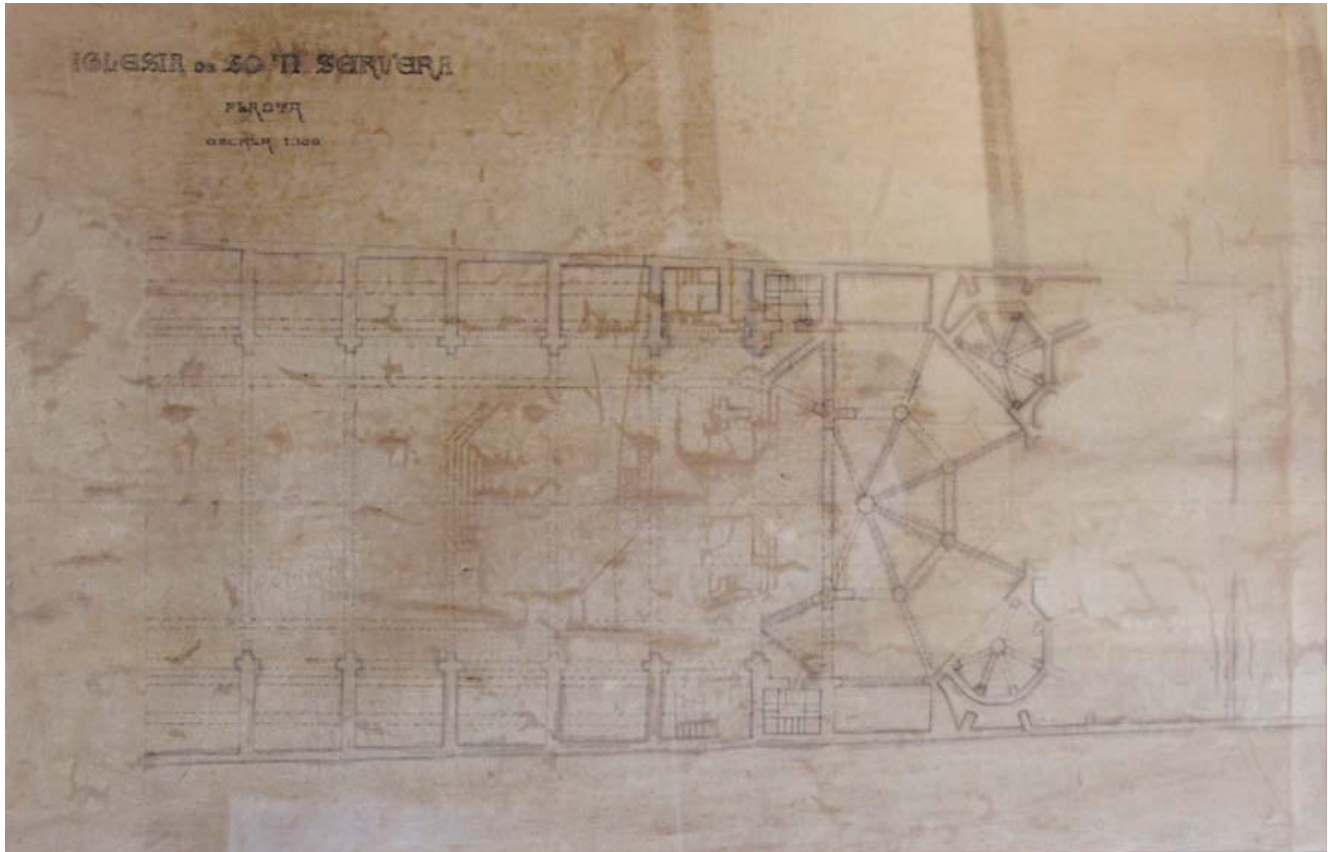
Plano de la planta de la *Església Nova*. Versión final
